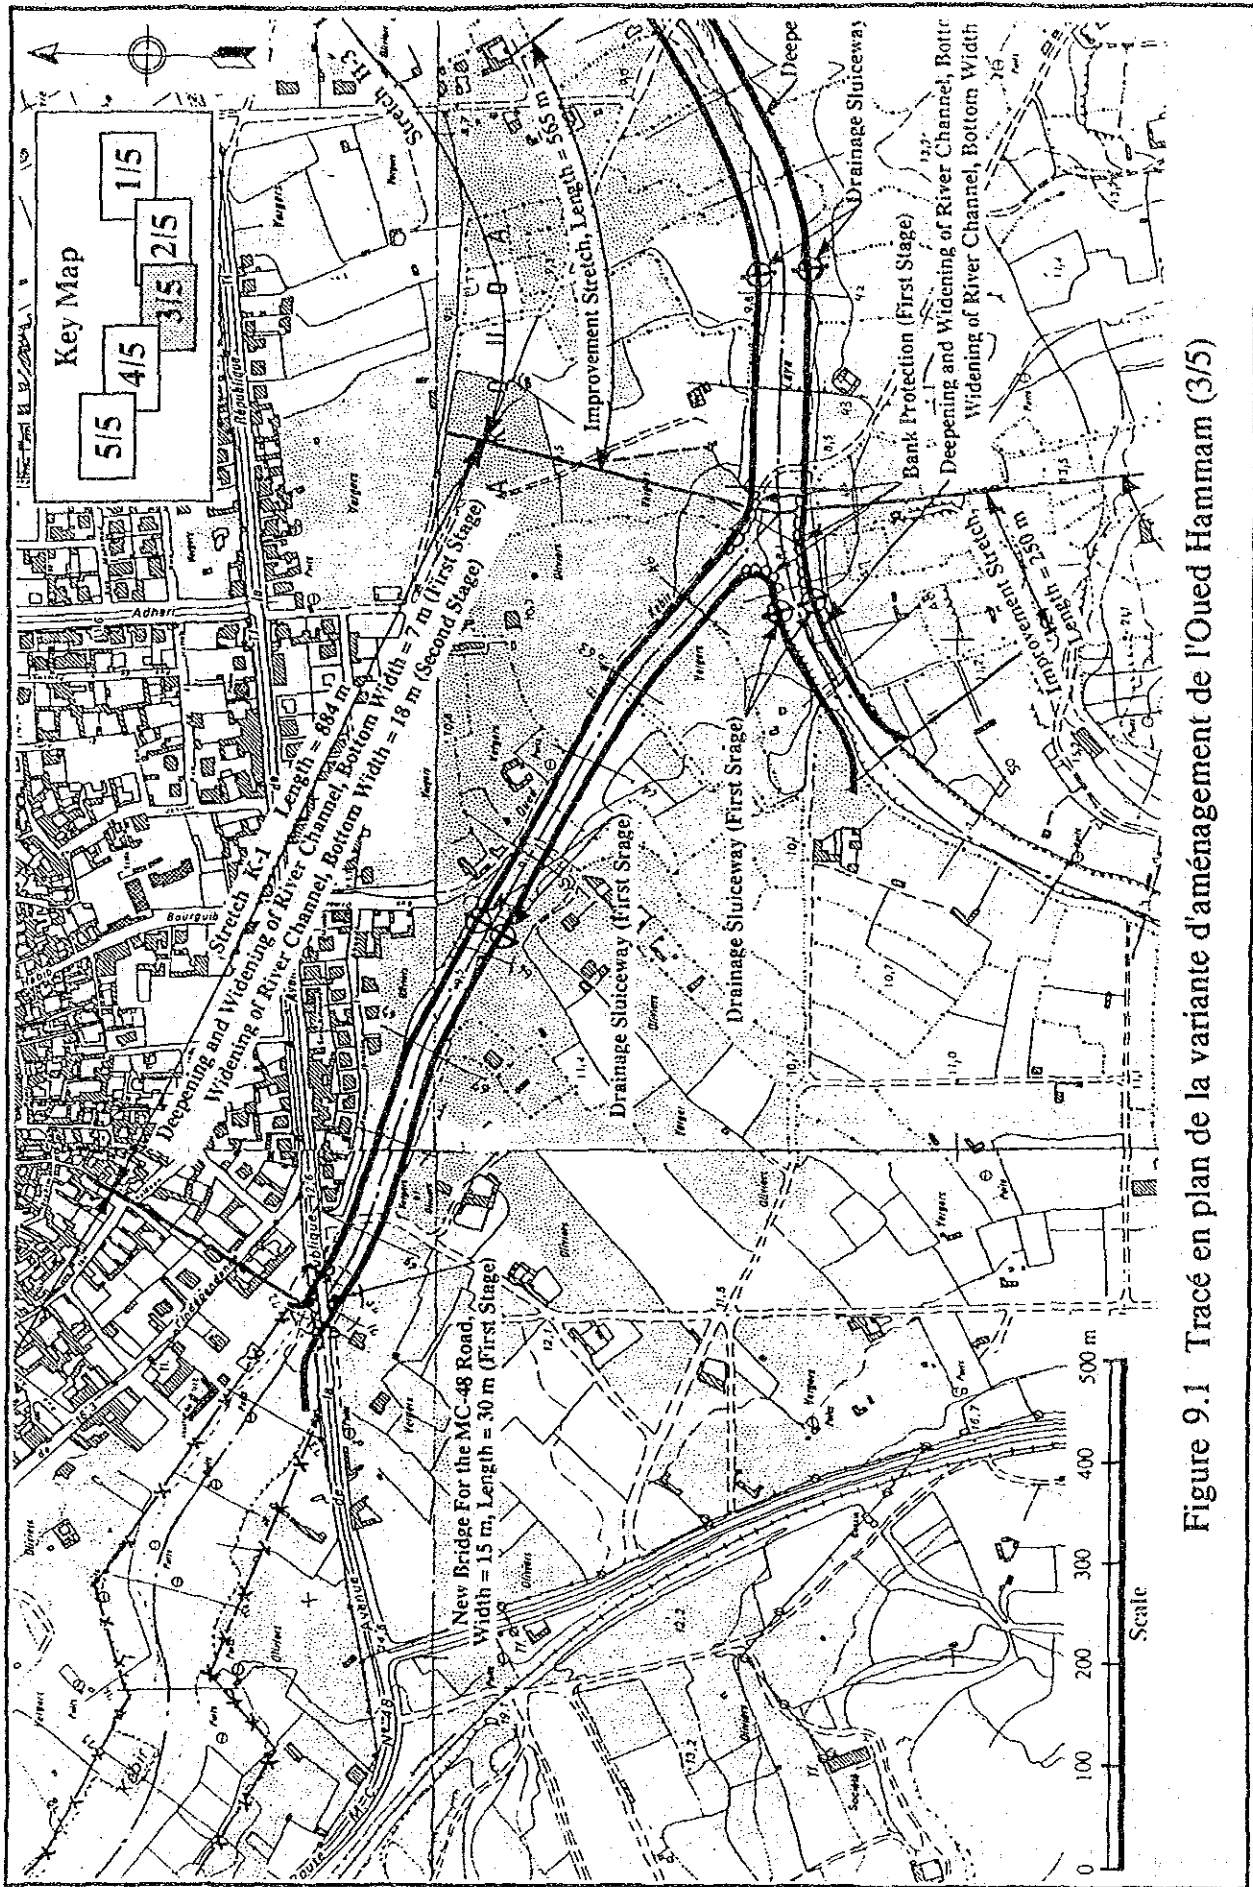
Tracé en plan de la variante d'aménagement de l'Oued Hammam (3/5)
